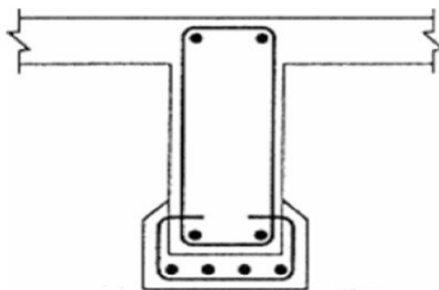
Aumento de secção de betão armado na face inferior de viga
